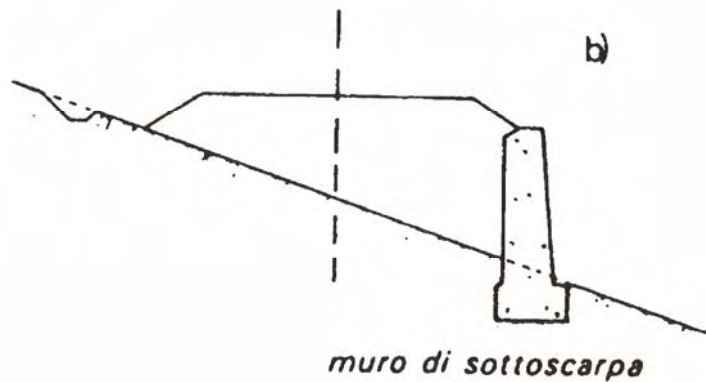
Costruzione di muro di sostegno per sezione stradale in rilevato
